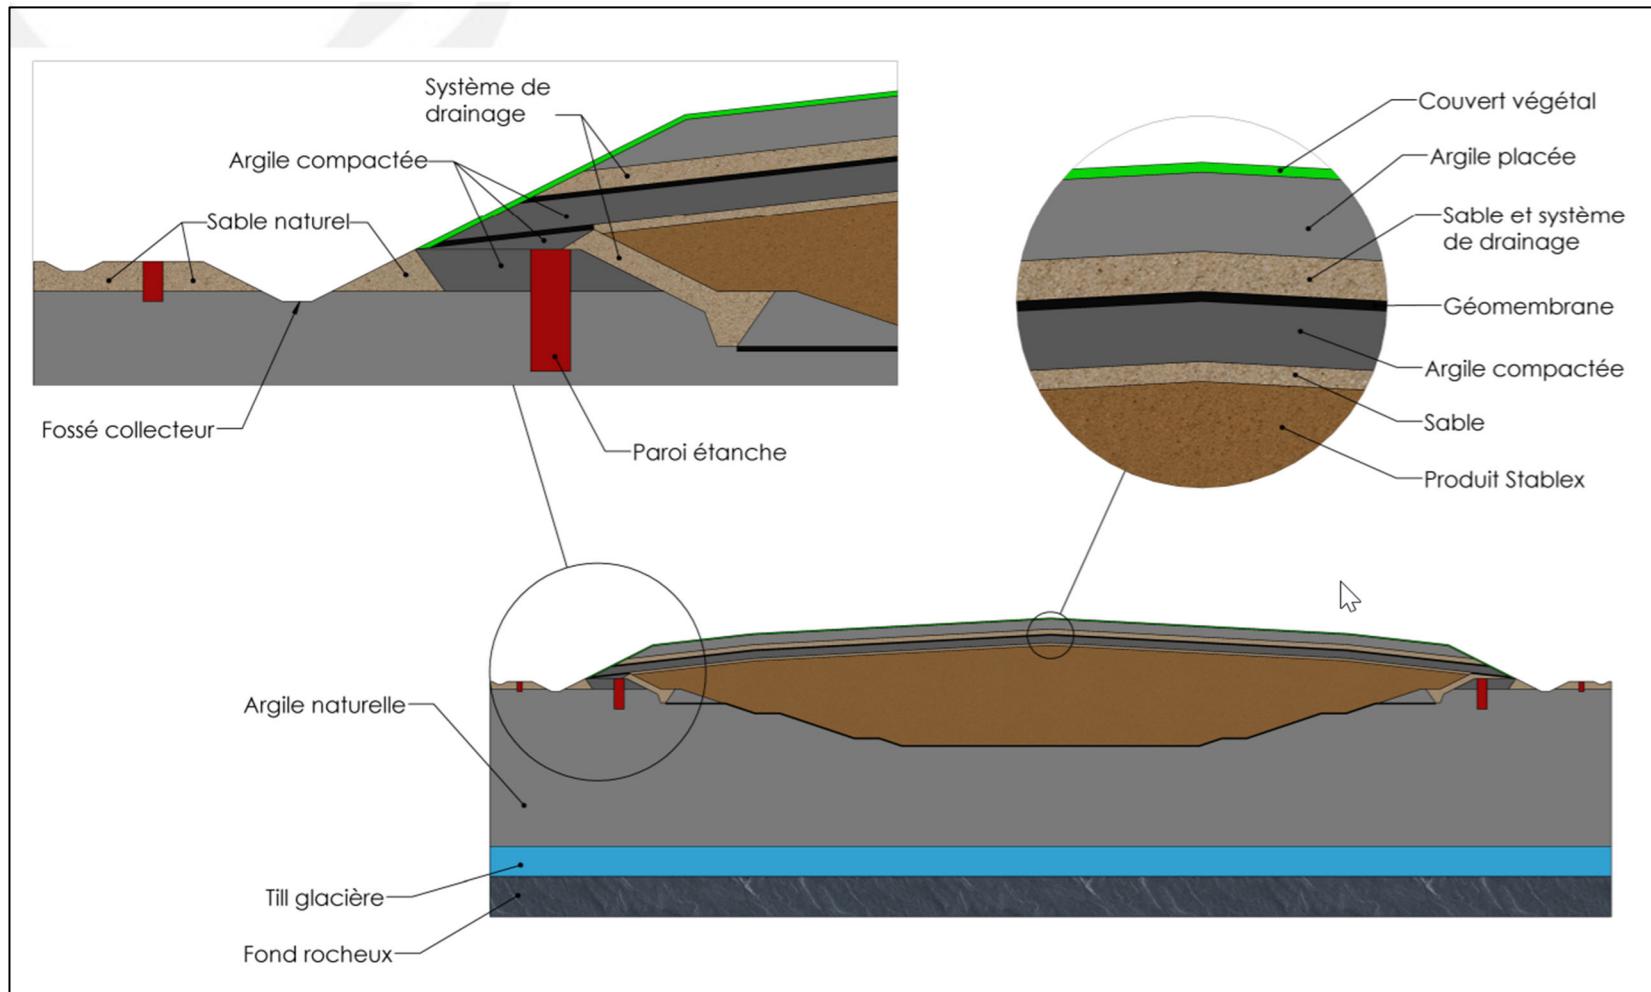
Coupe transversale du recouvrement multicouches de la cellule n° 6
